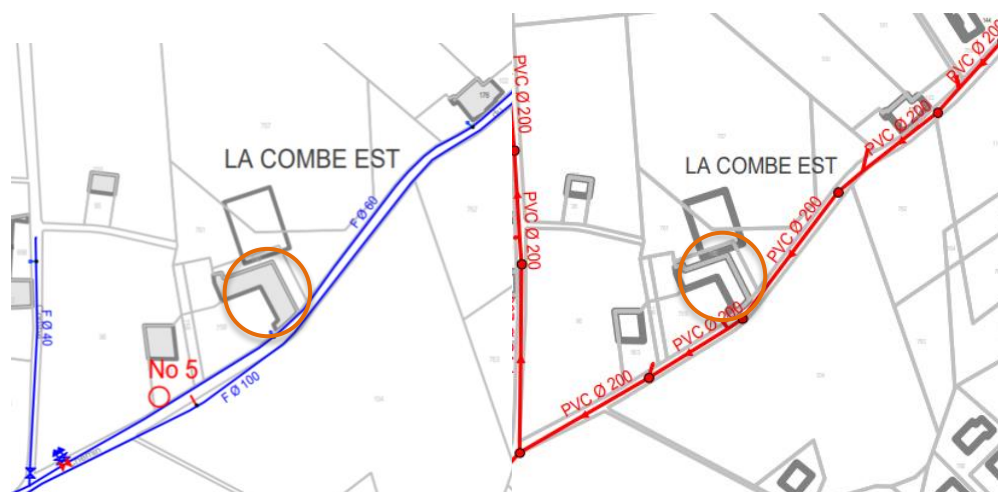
desserte en eau potable (gauche) et réseau d'assainissement (droite)
